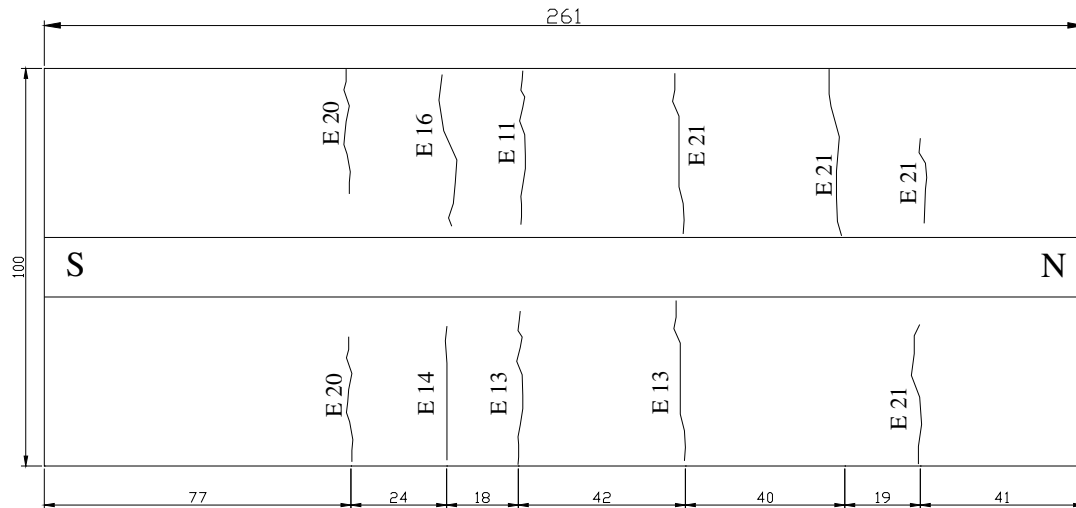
Fissuras do modelo 2A (Face inferior da laje) – medidas em cm.
